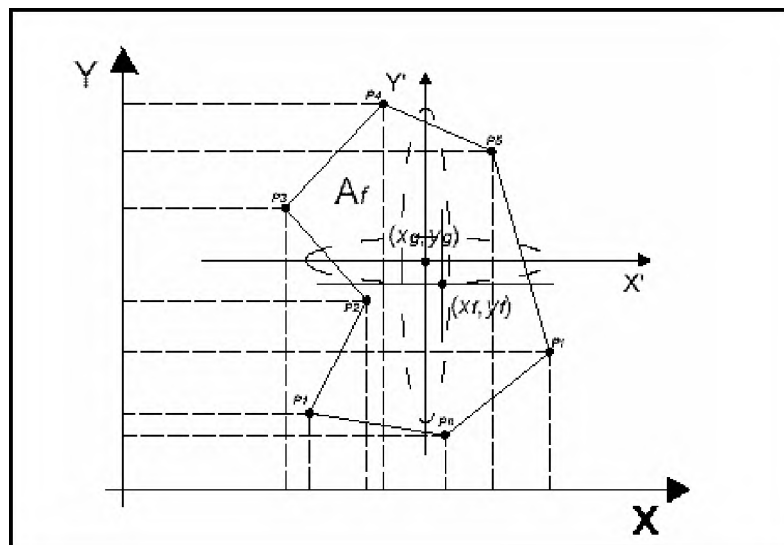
Forma general de una vista en planta considerada para el cálculo del parámetro 6.
